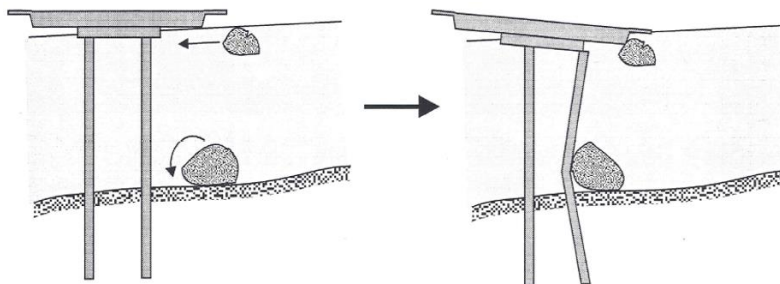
Daños en la estructura de puentes debido al arrastre de materiales pesados (Melville y Coleman, 2000).
